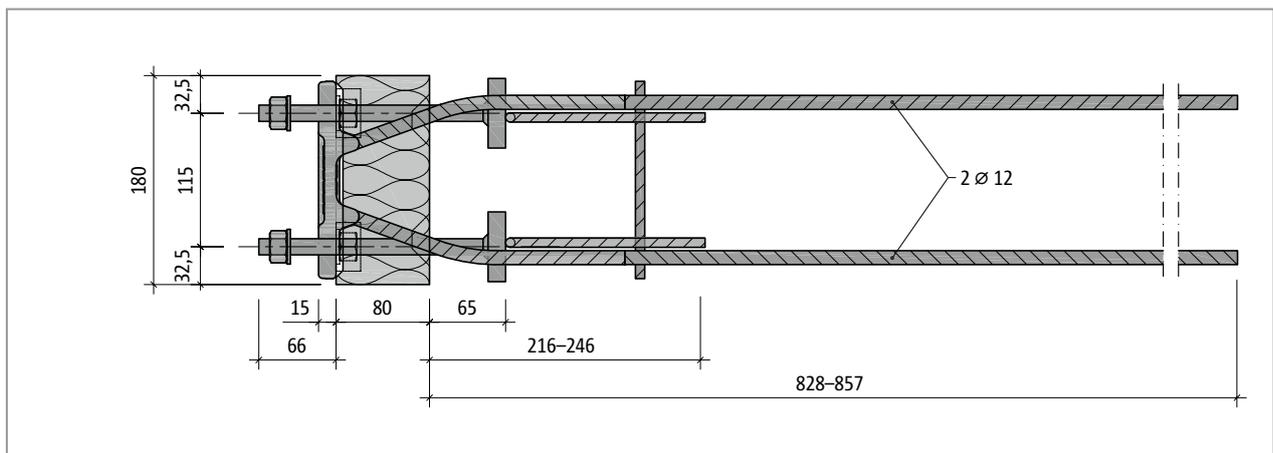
Schöck Isokorb® T tipo SQ-V3: Plano
